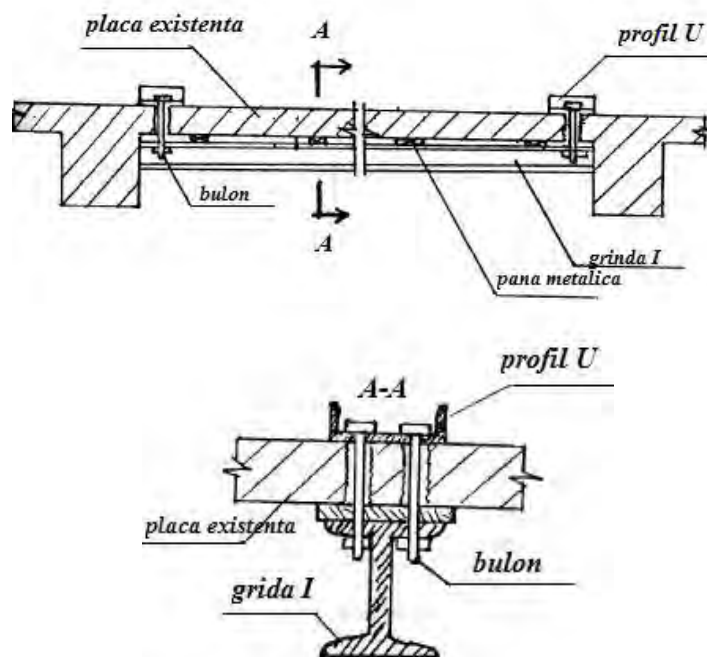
Consolidarea grinzilor din beton armat cu profiluri metalice [76]
